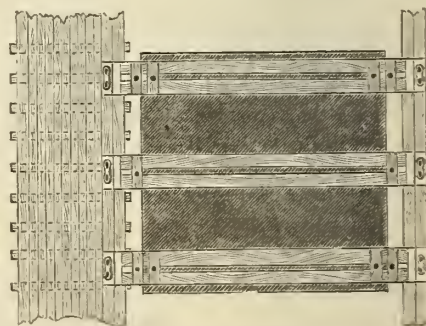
Grundriss des Versenkungsgerüsts.
